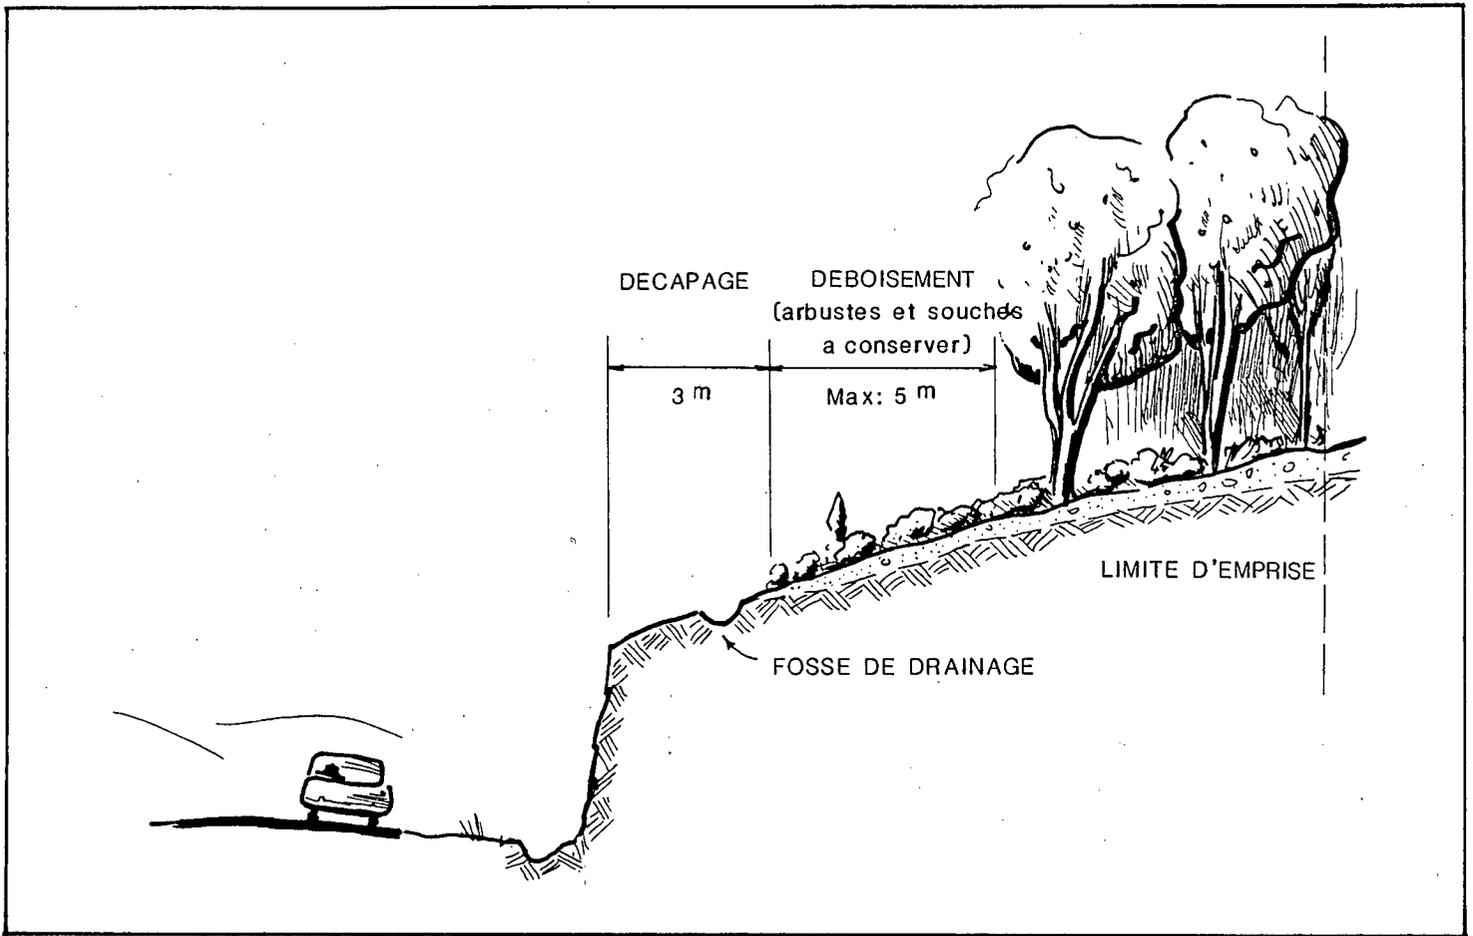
DEBOISEMENT DU HAUT D'UNE COUPE DE ROC AVEC FOSSE DE DRAINAGE
